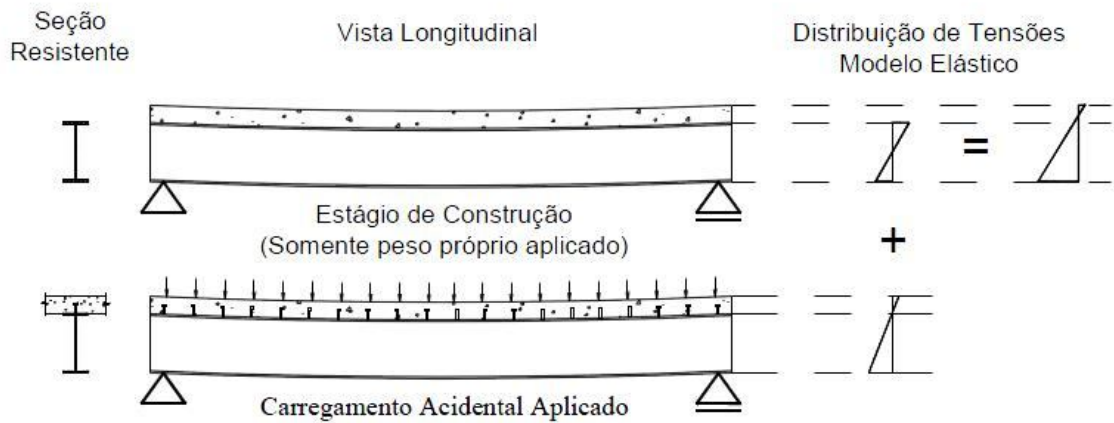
Viga mista não escorada (FABRIZZI, 2007)
